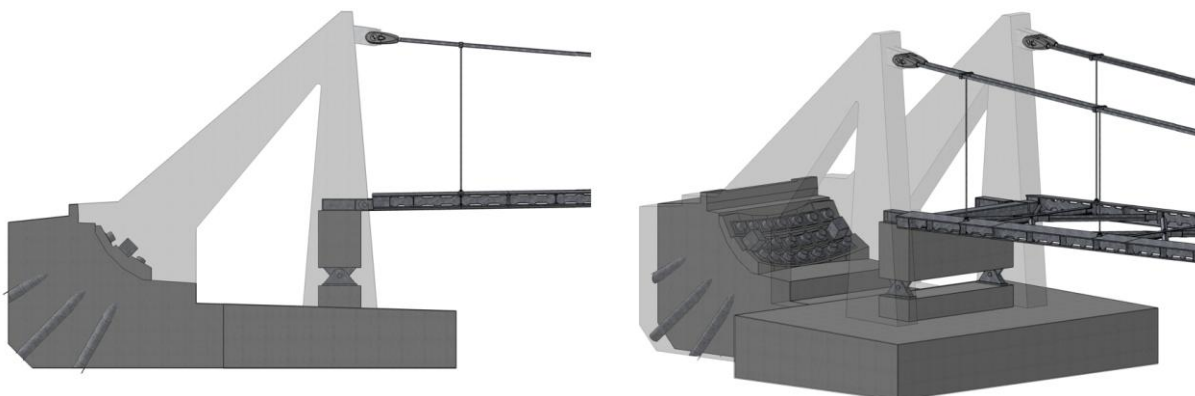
Längsschnitt durch Widerlagerkonstruktion mit Pendelwand; 3d-Ansicht
